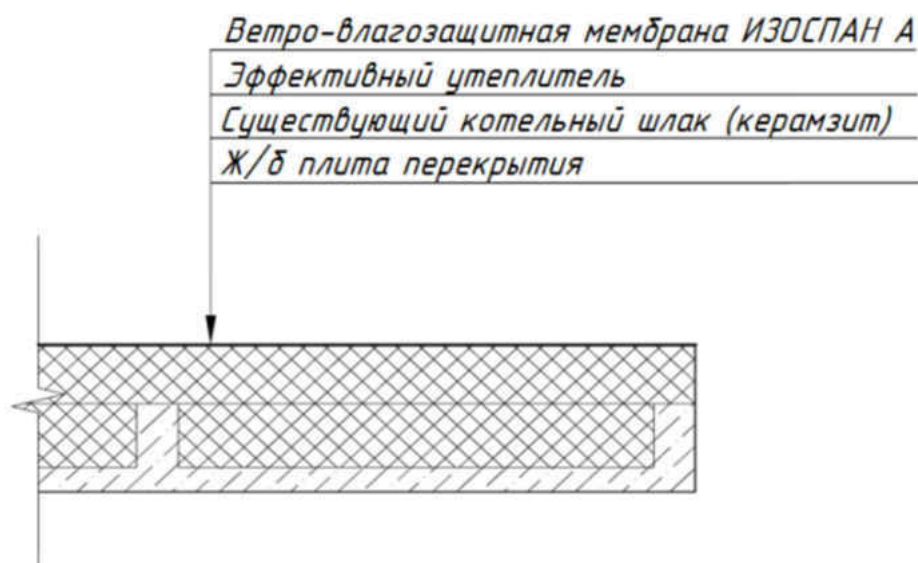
Утепление чердачного перекрытия железобетонного (ребристые плиты)
